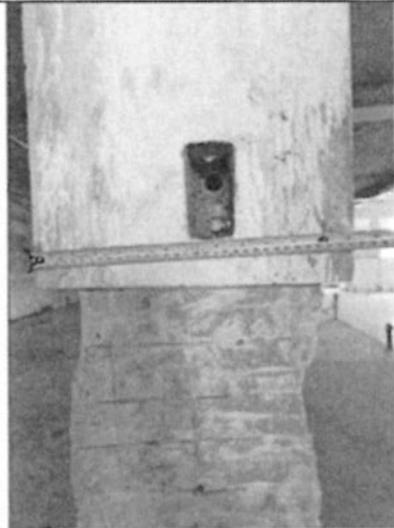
Vista de las columnas picadas para luego ser enchapadas con mayólica.
